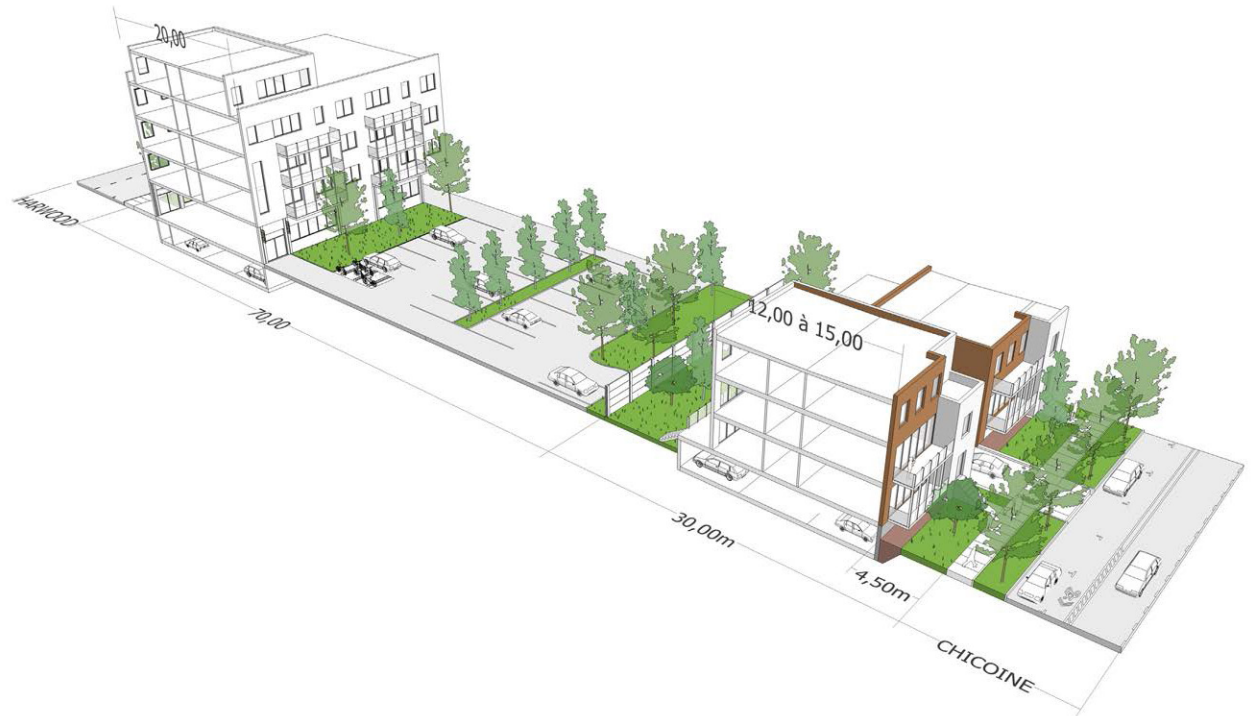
Coupe type illustrant la transition harmonieuse entre les nouvelles constructions sur le boulevard Harwood et celles de la rue Chicoine
